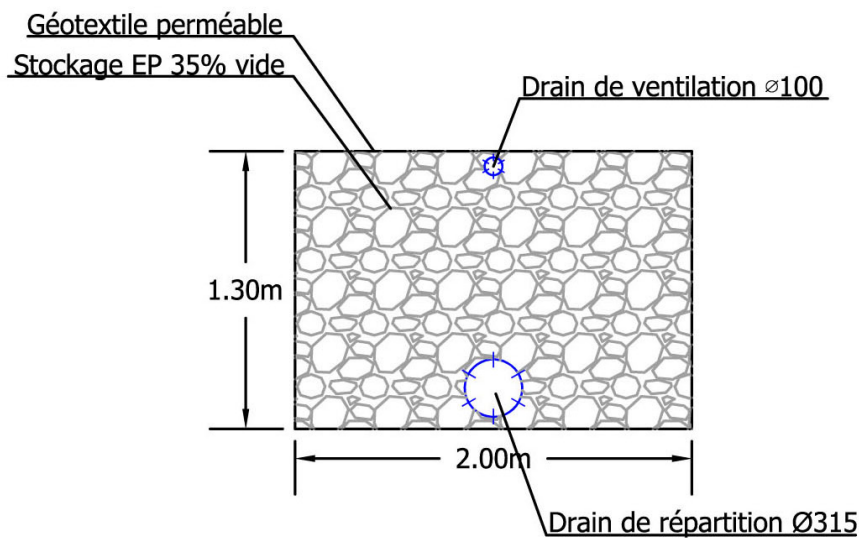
Coupe transversale des tranchées d'infiltration du projet
